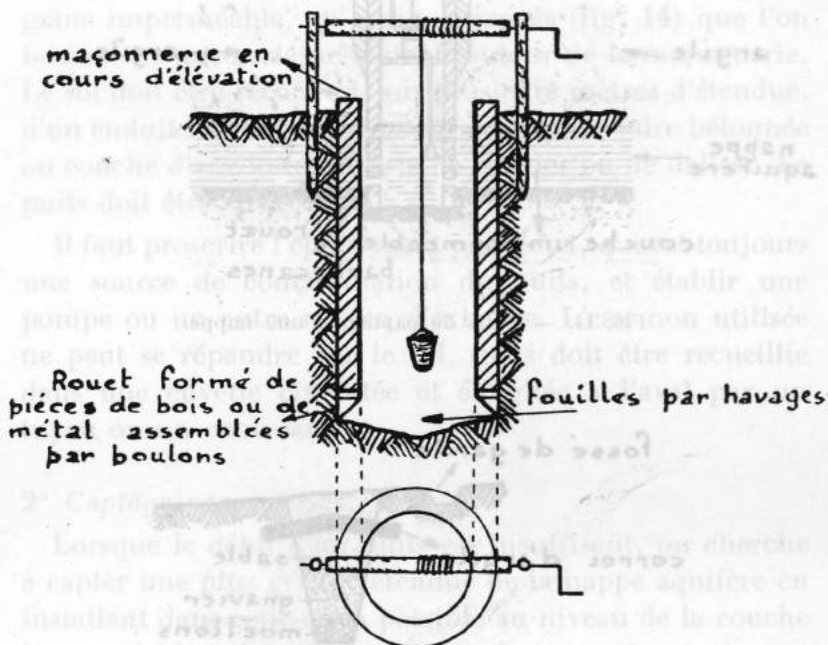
Construction d'un puits en maçonnerie sur rouet.
